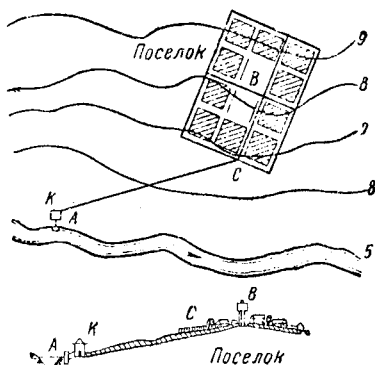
Схема напорного водопровода из реки: А — водоприемник, К — насосная станция, В — водонапорная башня, КСВ — трубопровод.
